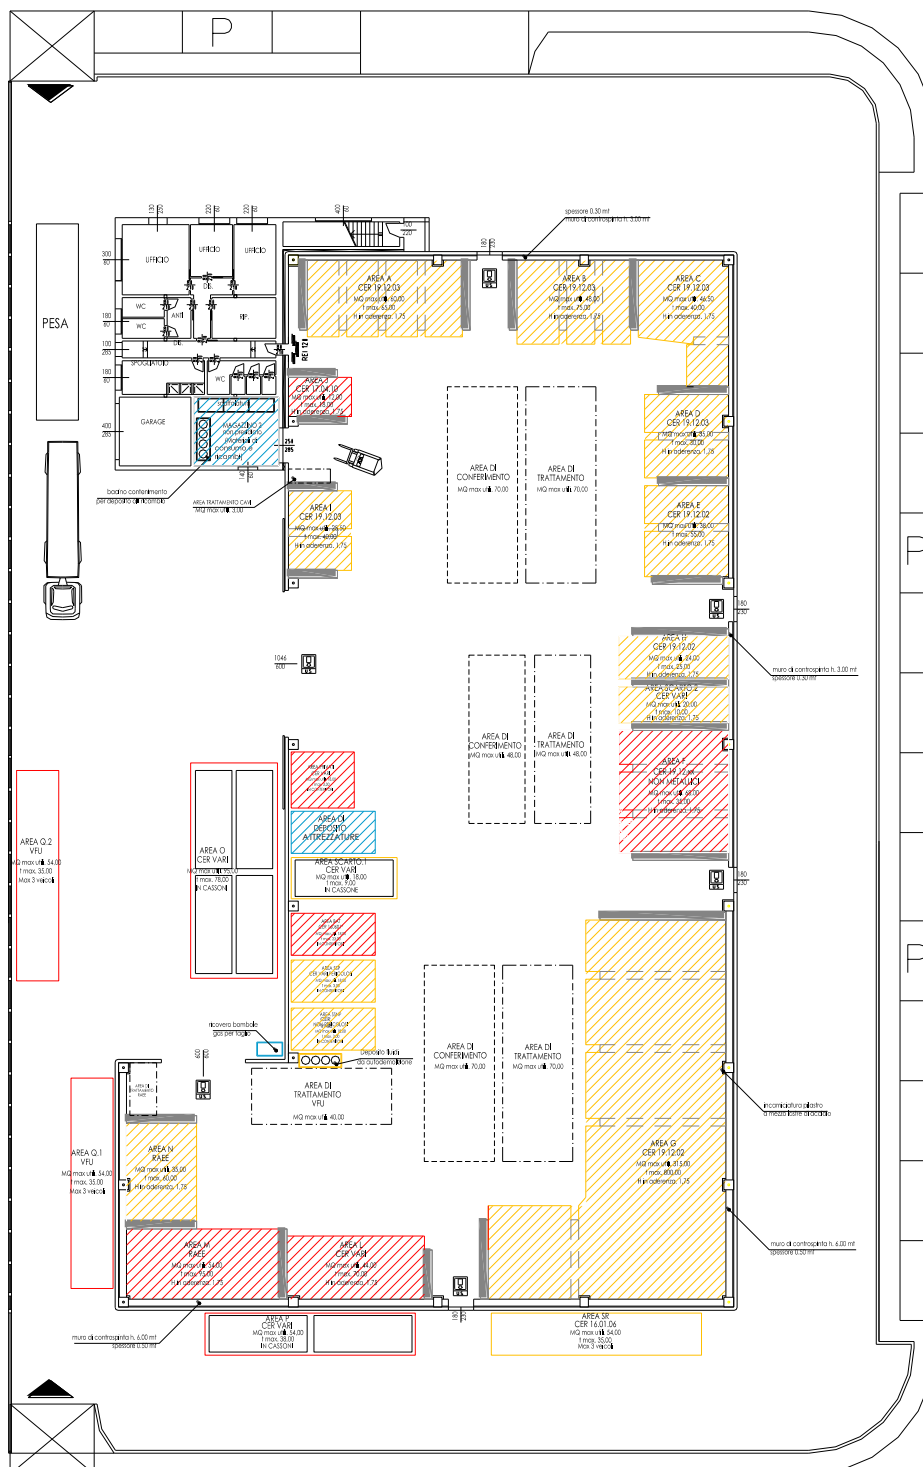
Estratto della Planimetria A 2.15 "Layout impianto di gestione dei rifiuti"
